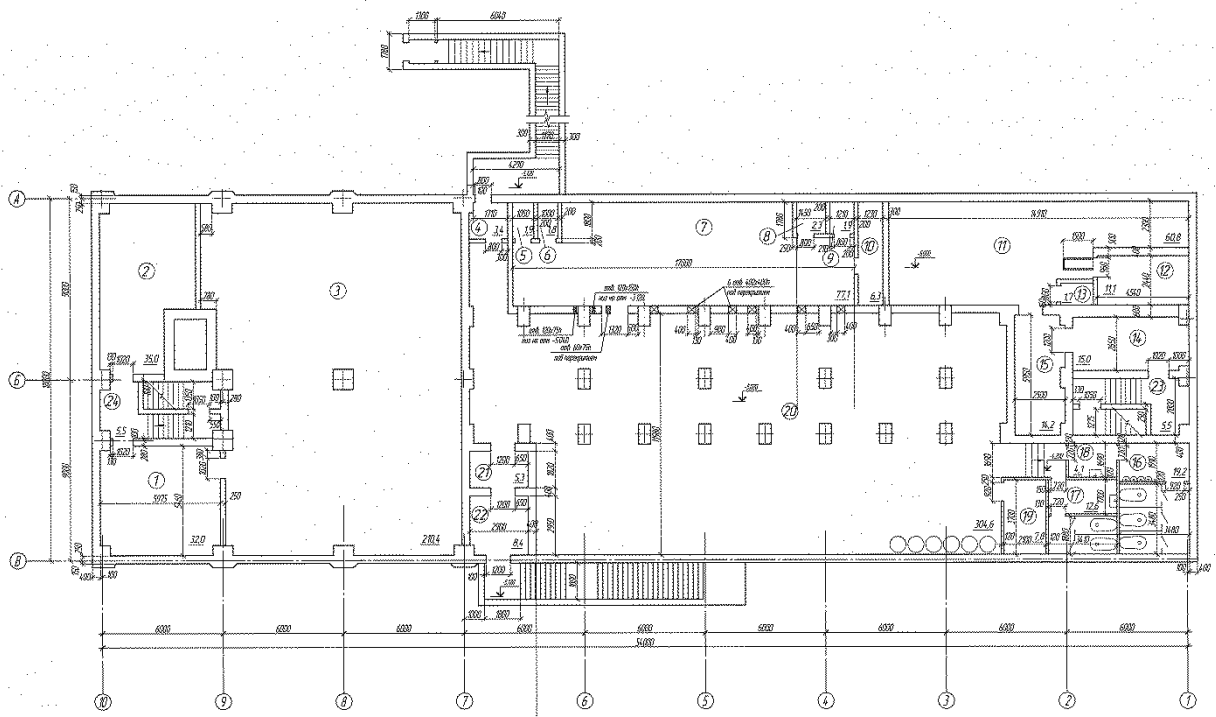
Планування вбудованого ПРУ на 600 осіб
